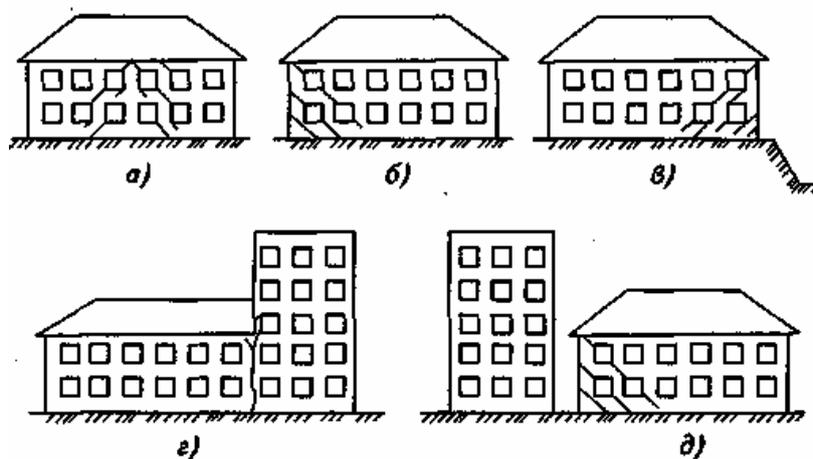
Причины образования трещин в несущих стенах из-за неудовлетворительного состояния оснований и фундаментов: *a* – слабые грунты под средней частью здания; *б* – то же у торца здания; *в* – обширная выемка грунта в непосредственной близости от здания; *г* – отсутствие осадочного шва между частями здания разной высоты; *д* – близкое расположение нового многоэтажного здания возле малоэтажного
